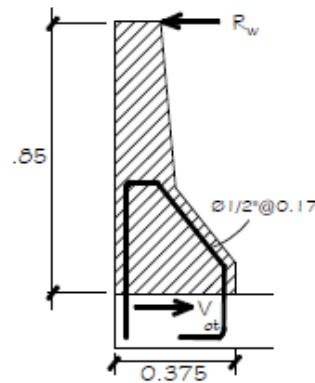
Fuerza horizontal actuante entre la barrera New Jersey y la losa de volado.
